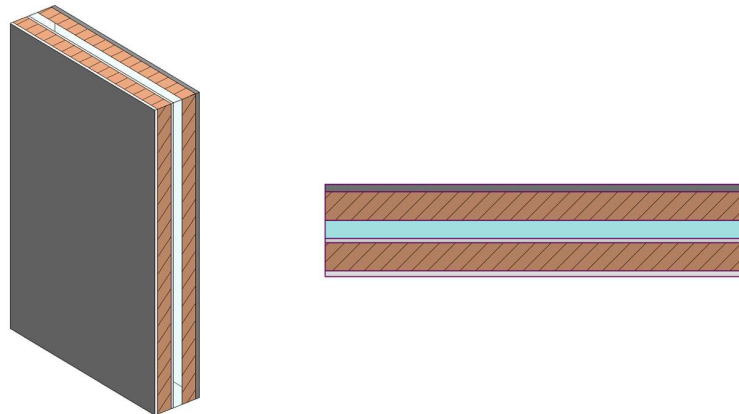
Vista en 3D y en planta del Muro 1.
